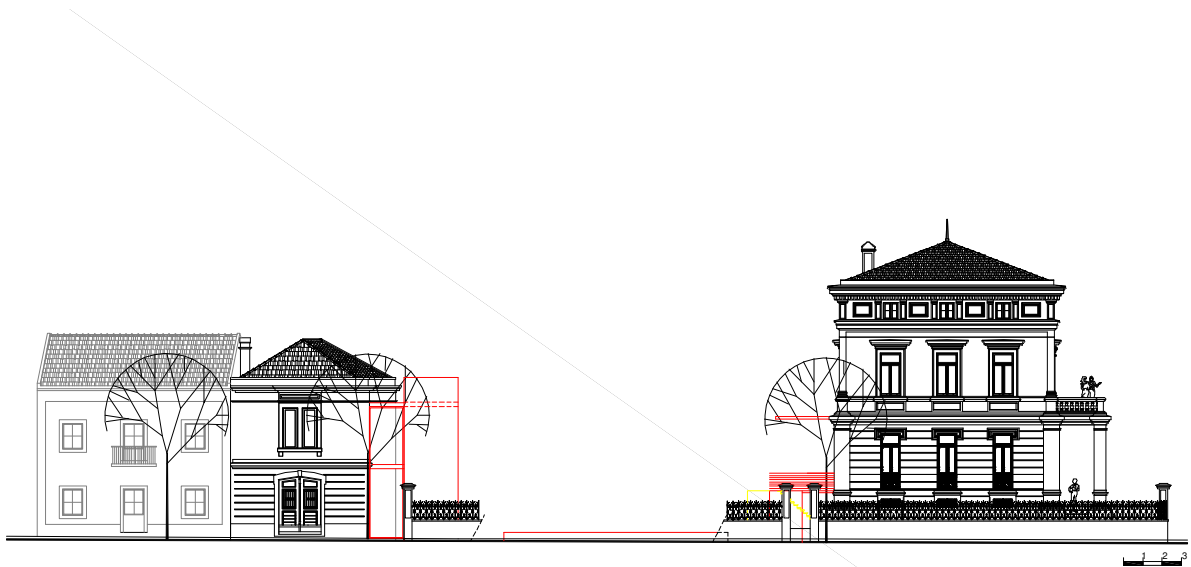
Alçado Poente Conjunto com indicação das Cores Convencionais
